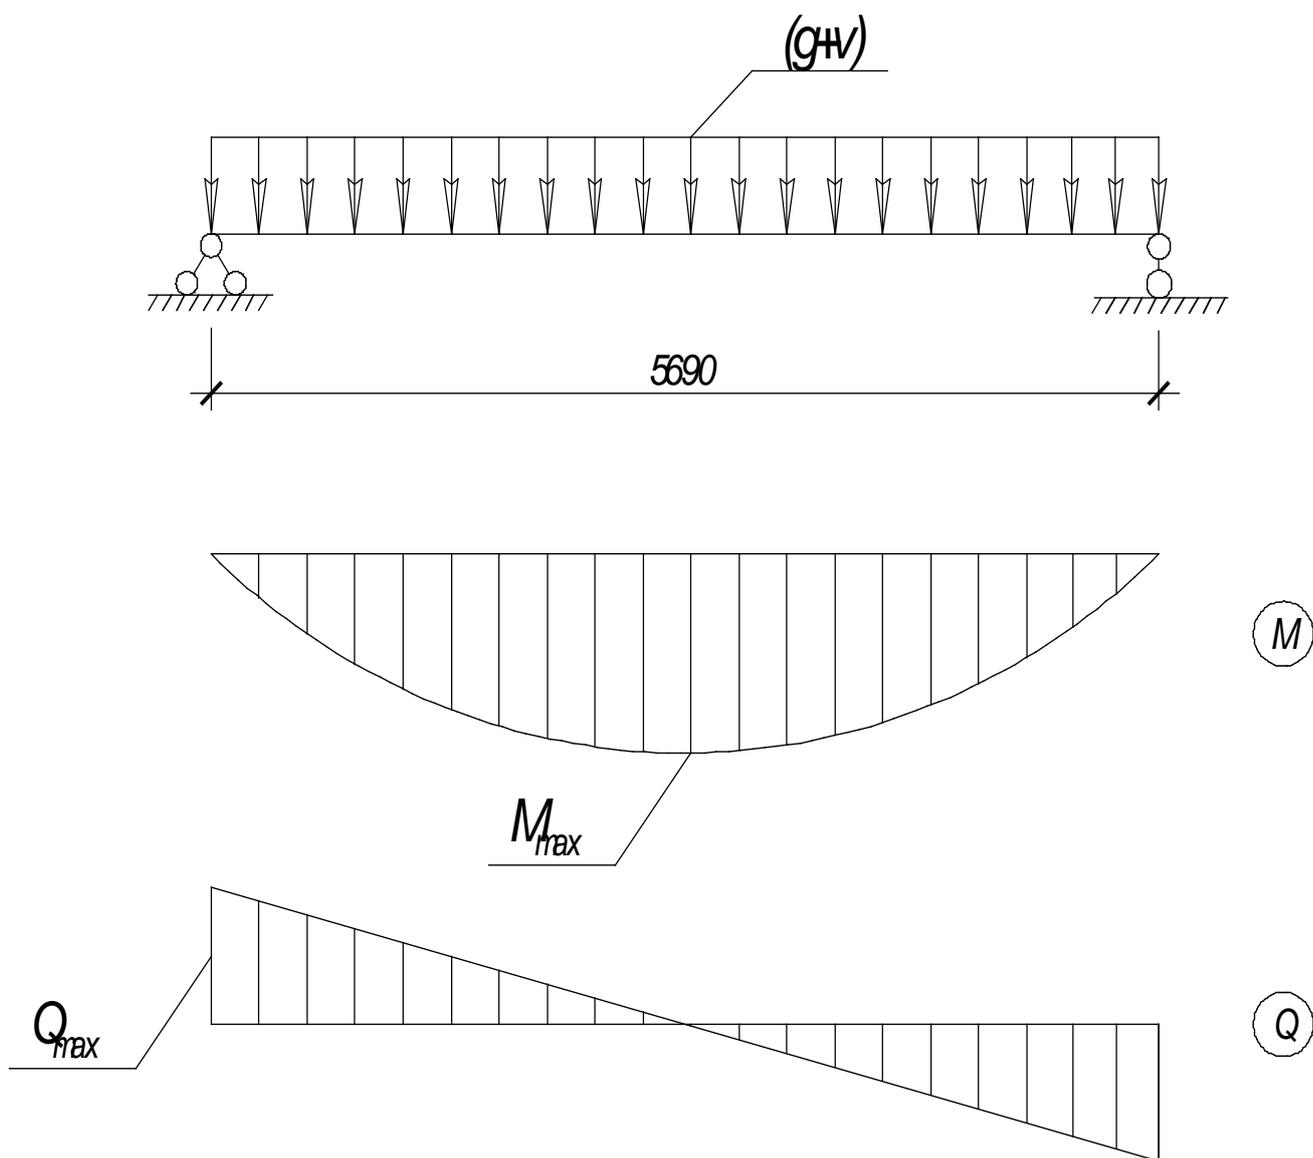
Расчетная схема плиты и эпюры усилия
